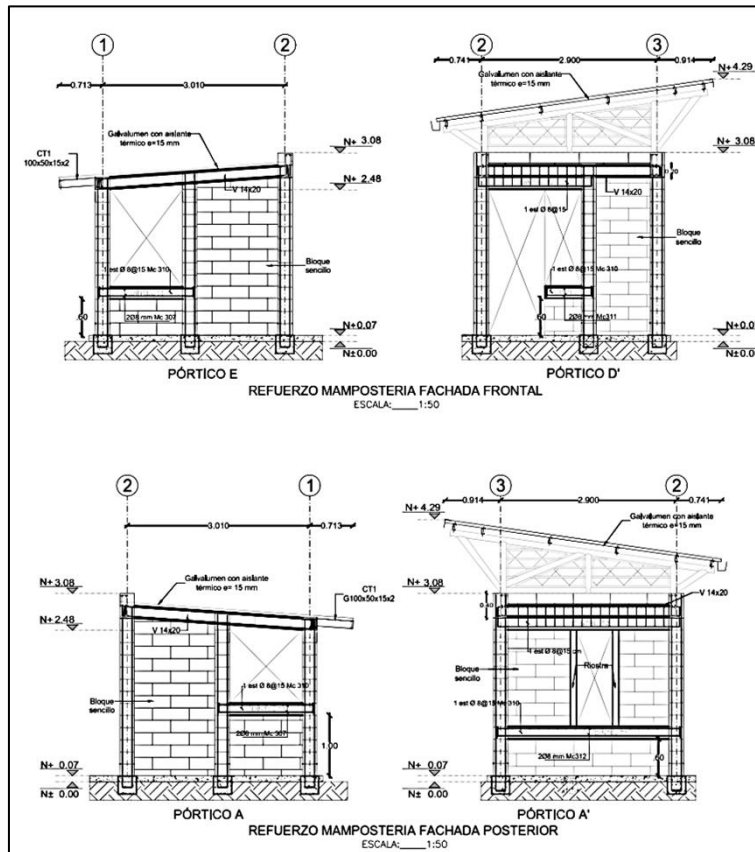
Pórticos de vivienda en hormigón armado Fuente: (MIDUVI, 2023)
